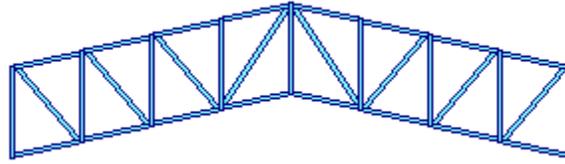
Armadura Pratt-Howe, 8 Paneles.
